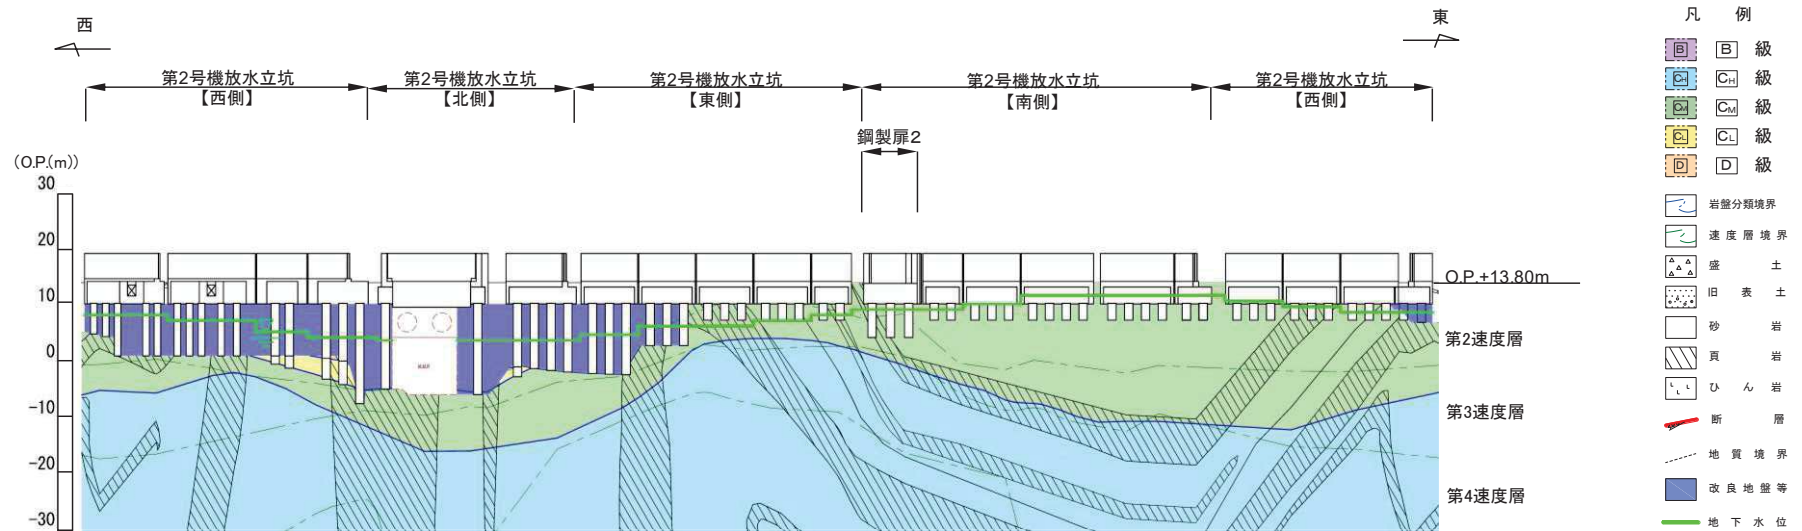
(2) 鋼製扉周辺の地質状況 (第2号機放水立坑)
